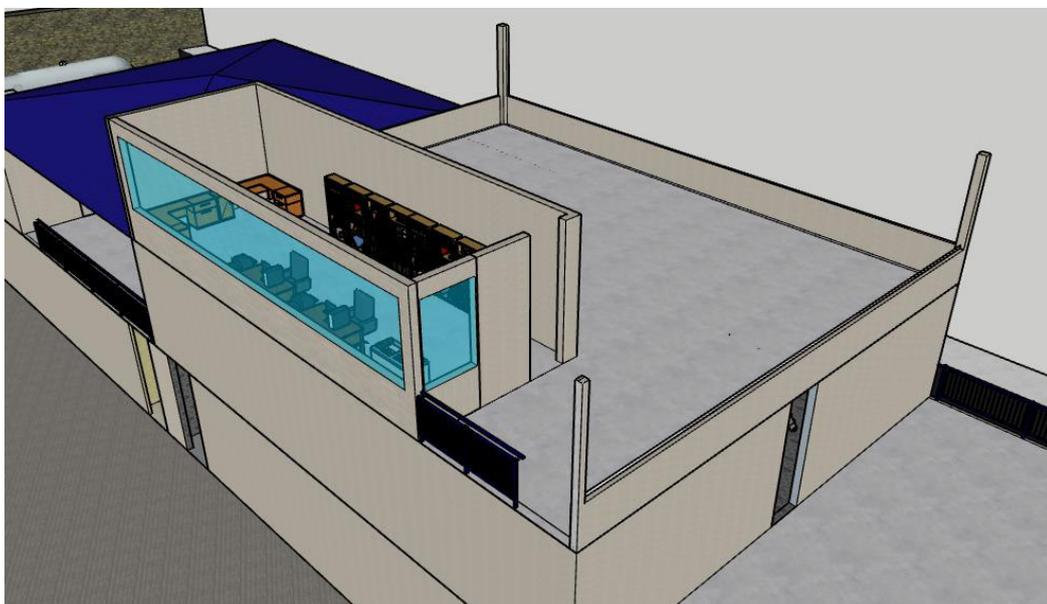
Planta segunda del adiestrador de fuegos interiores modelada en SketchUp
